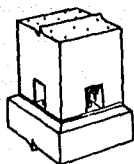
CONEXIONES ENTRE COLUMNA Y CIMENTACION
